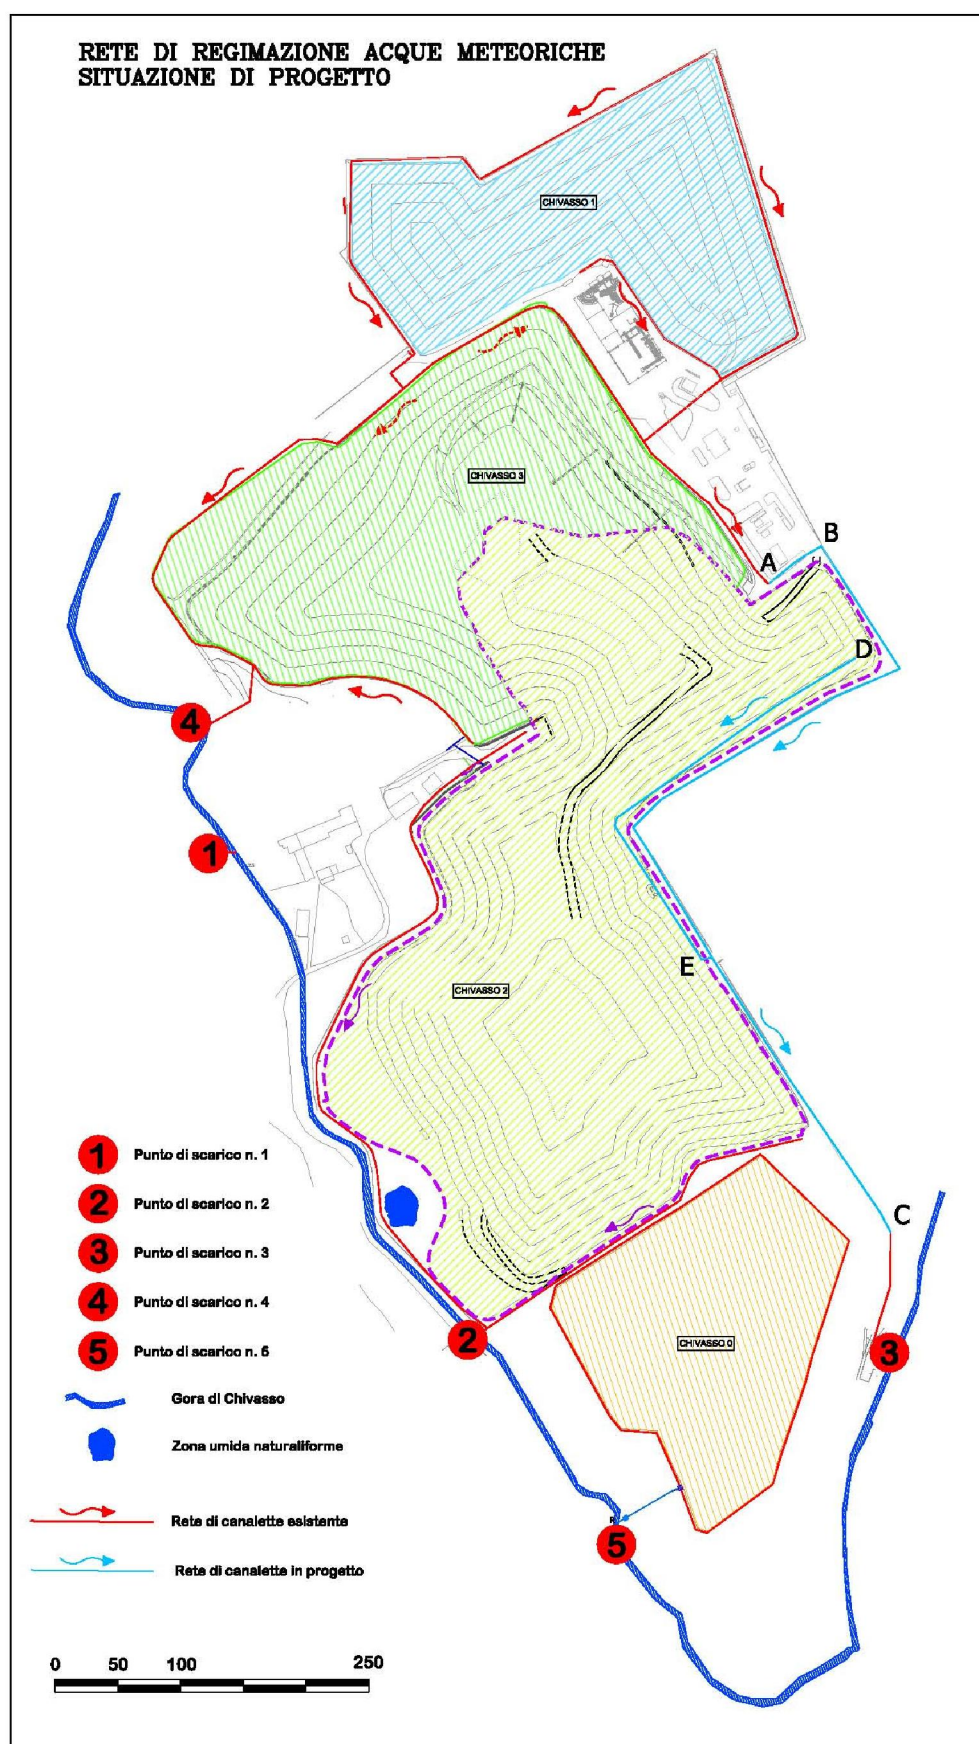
Planimetria della regimazione delle acque meteoriche – stato di progetto
